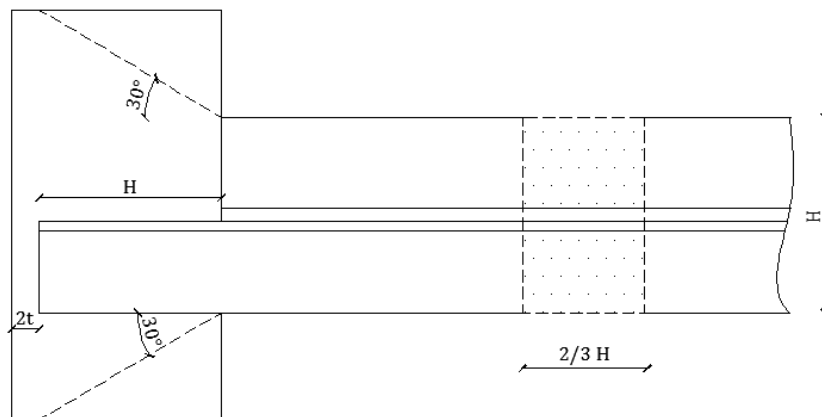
Geometría general de la placa gusset y conector intermedio.
